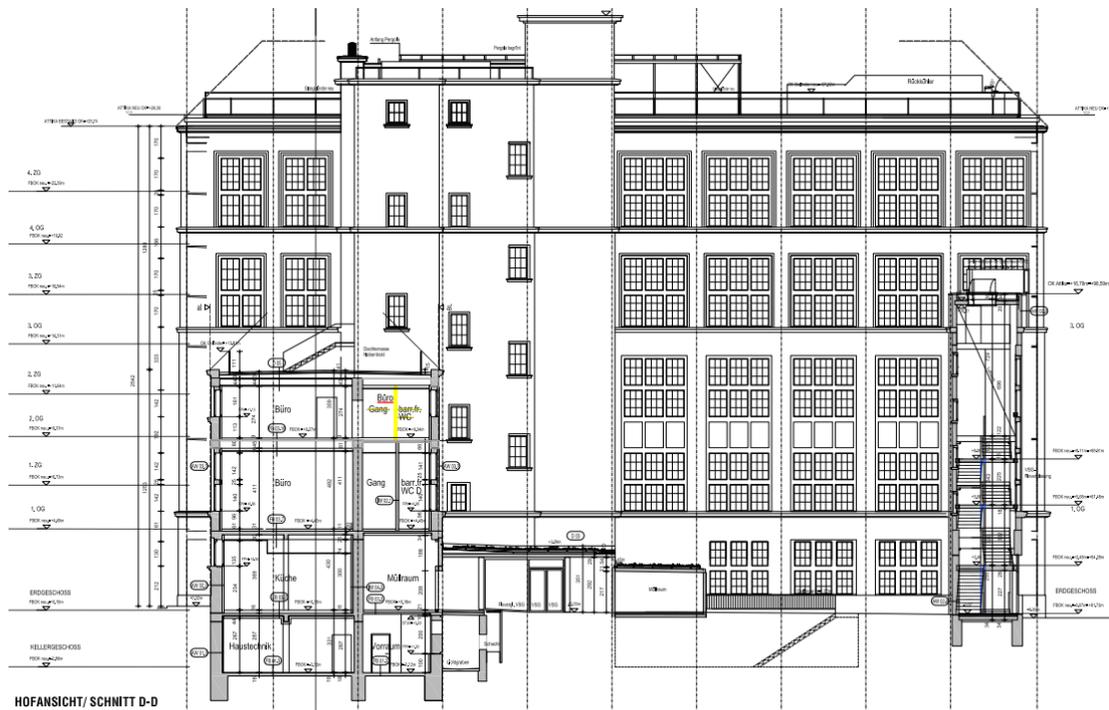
Ausführungsplan: Ansicht Hofansicht, Planverfasser: ostertag ARCHITECTS gmbh
